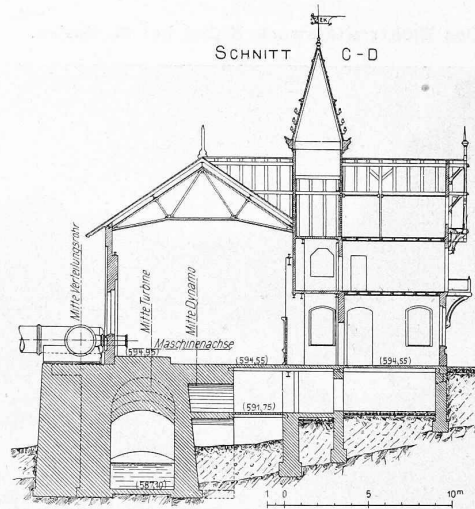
Schnitt durch Maschinenhaus, Schalraum und Werkstätte. — Masstab 1:400.
